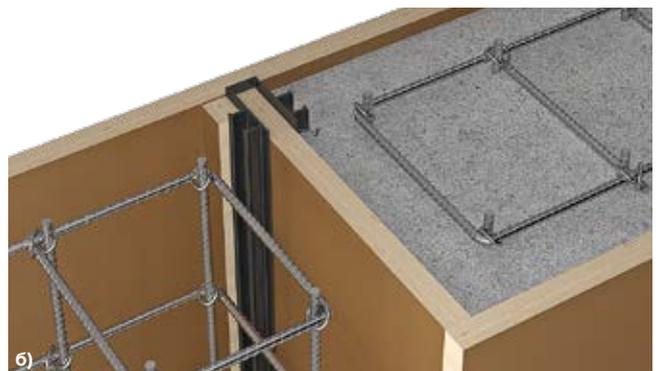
Этапы работ по установке гидрошпонок серии TH Фундамент ДШП
